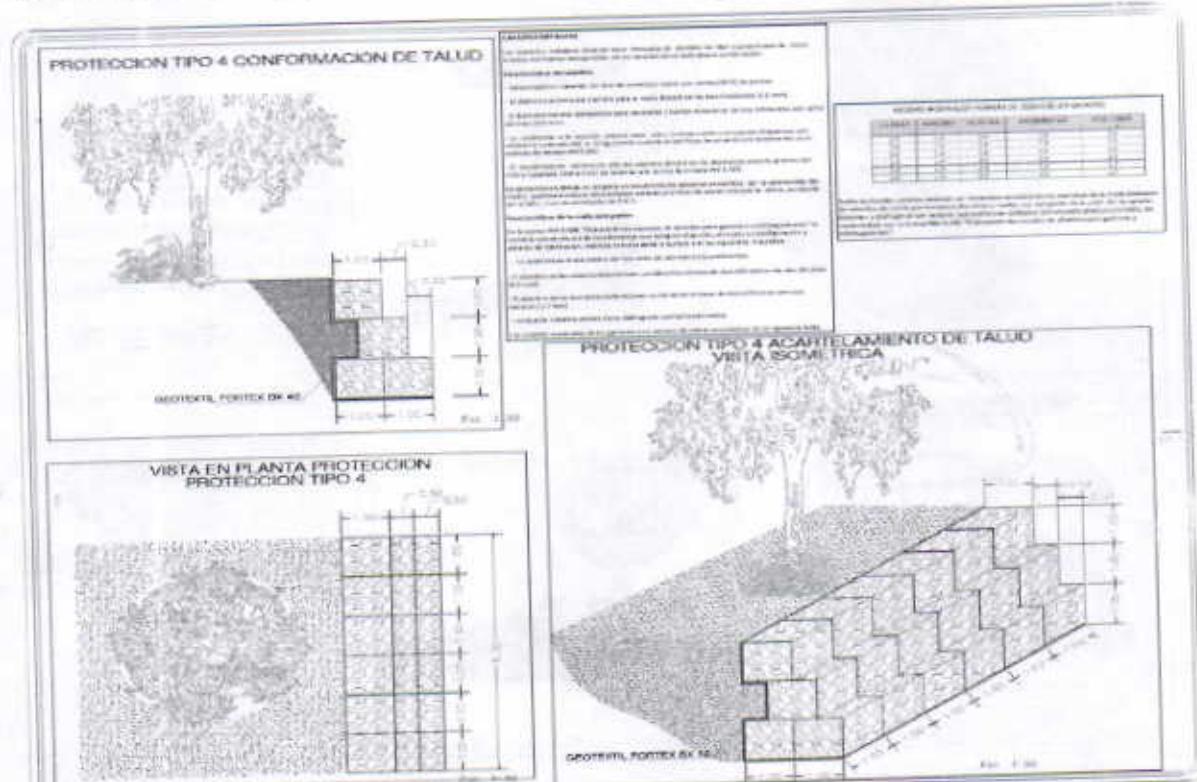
Imagen Tipo, Planos Planta, perfil e isométrico General de solución de protección TIPO No 4
